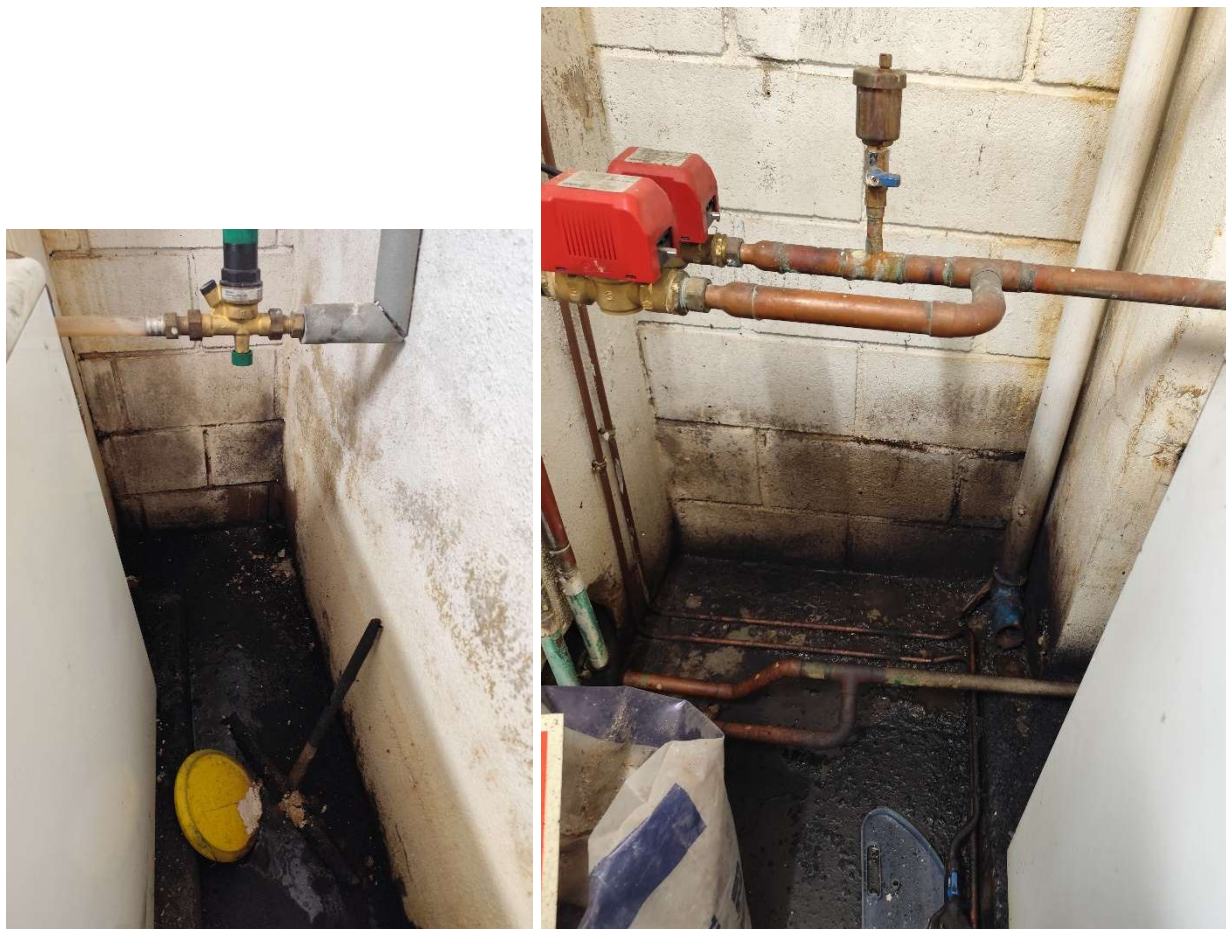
y 43 – Desperfectos Sala de Calderas, muros sin impermeabilización.
